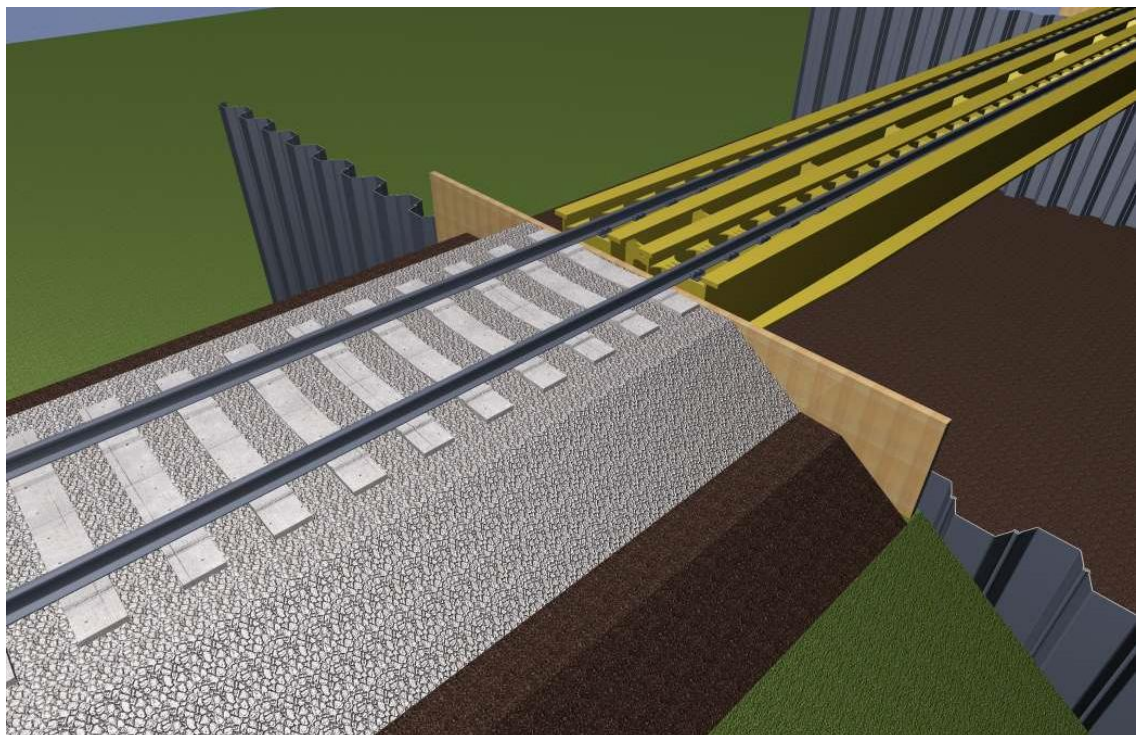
Ausgangssituation - 3d-Modell - Übergang Bahnkörper zu Hochleistungshilfsbrücke
